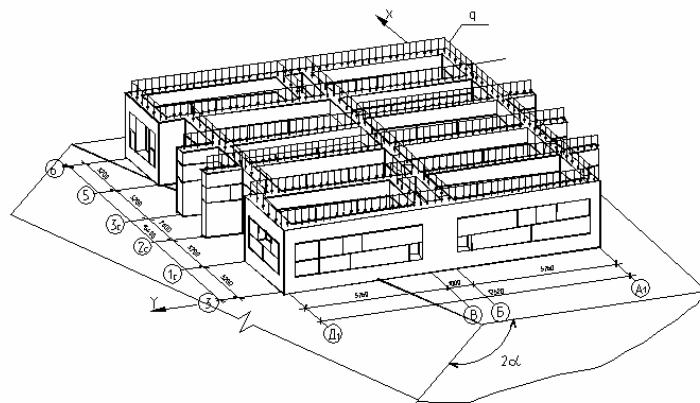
Пространственный железобетонный фундамент в виде системы перекрестных балок на упругом клиновидном основании
